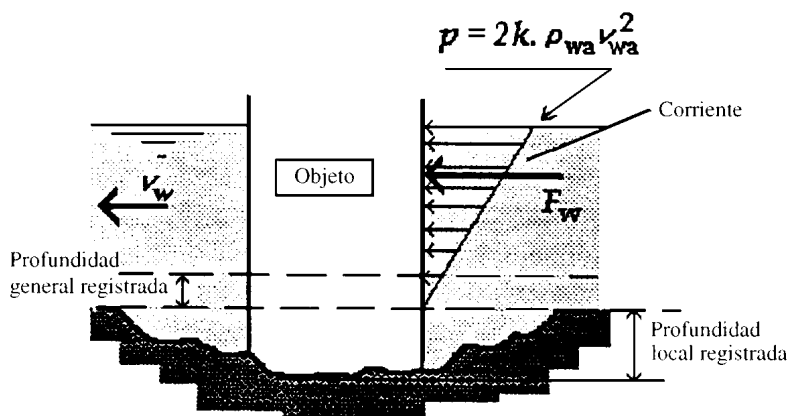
Presión y fuerza debida a corrientes en estribos y pilas de puentes
